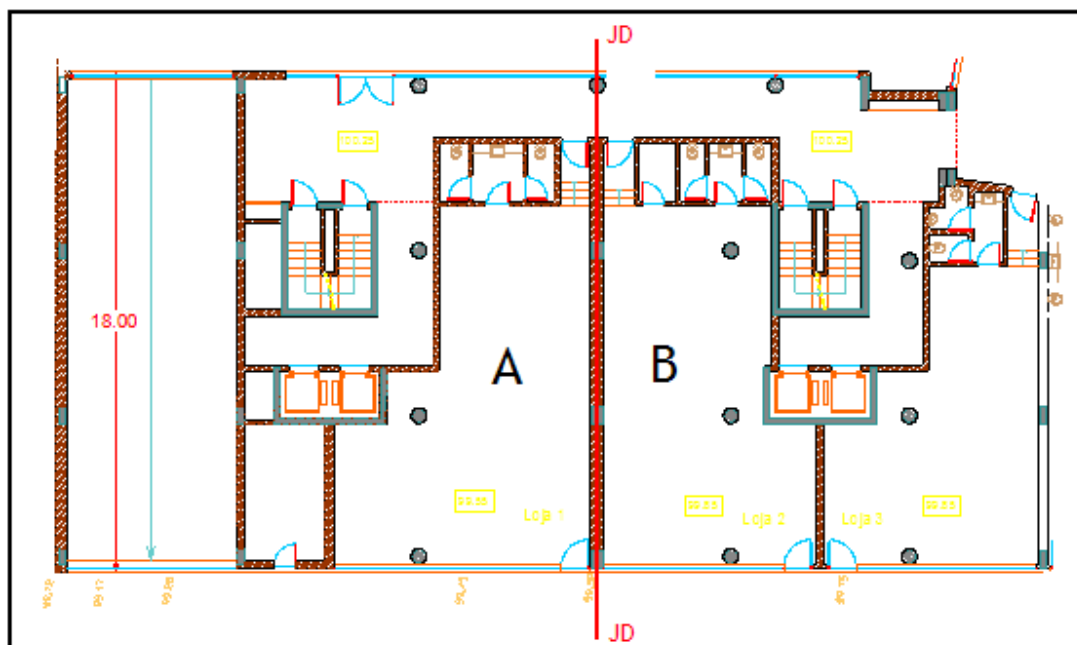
Planta de arquitectura (Corpo A à esquerda da JD e B à direita).
